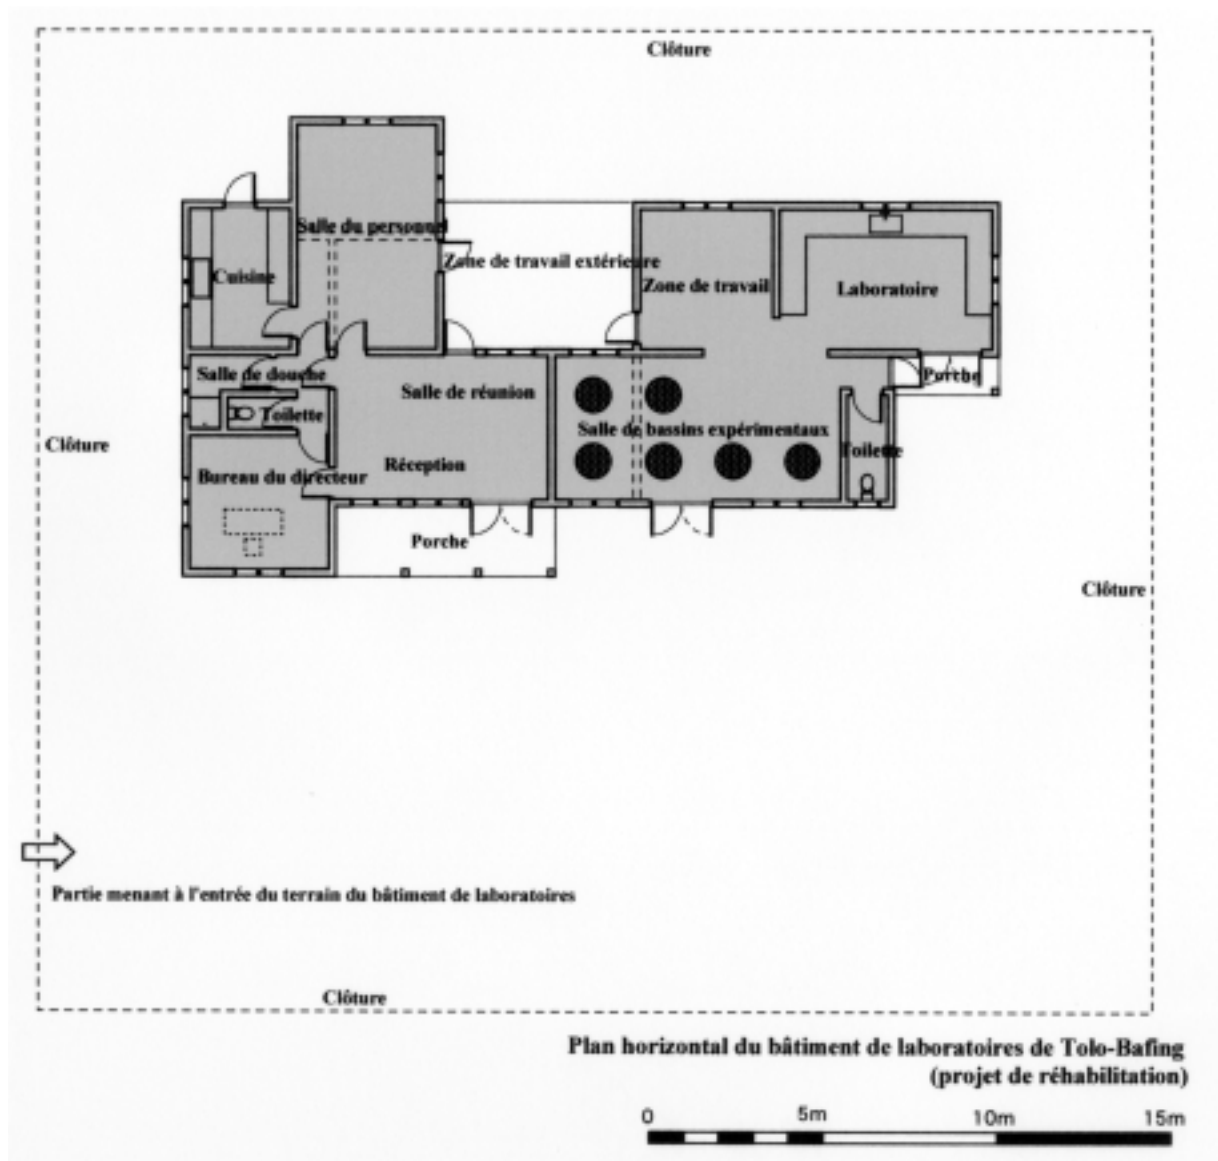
Plan horizontal du bâtiment de laboratoire de Tolo-Bafing
